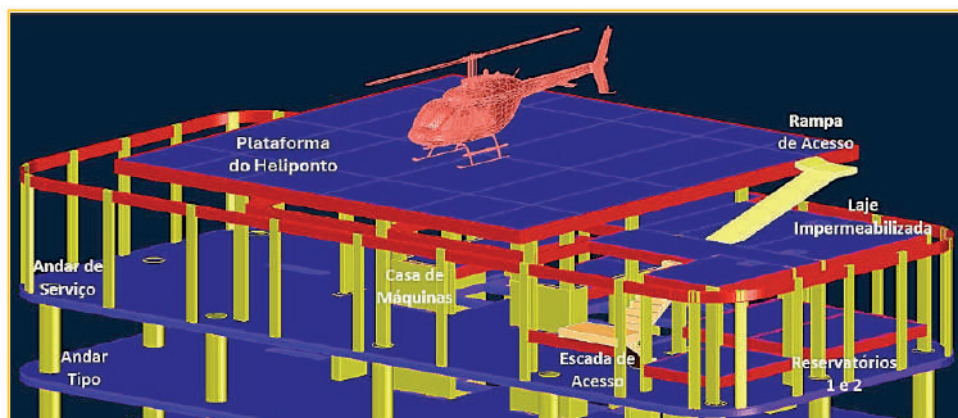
Tipologia arquitetônica e características estruturais de projeto de heliponto elevado do tipo padrão. Desenho do autor
